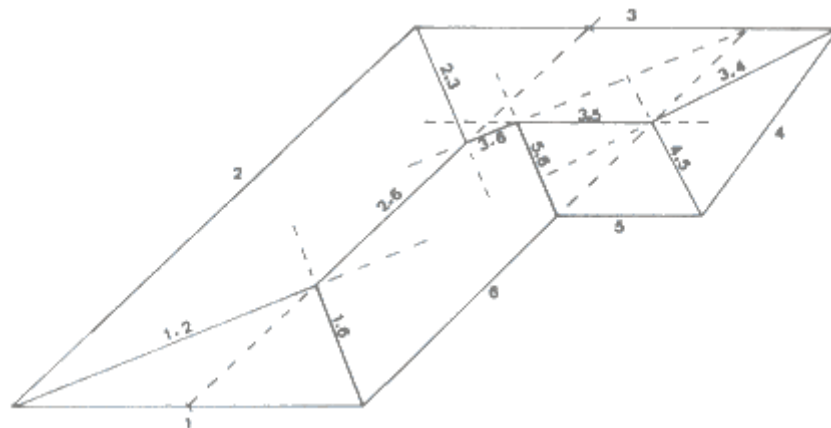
Subdivisão da planta por meio das bissetrizes dos ângulos.
